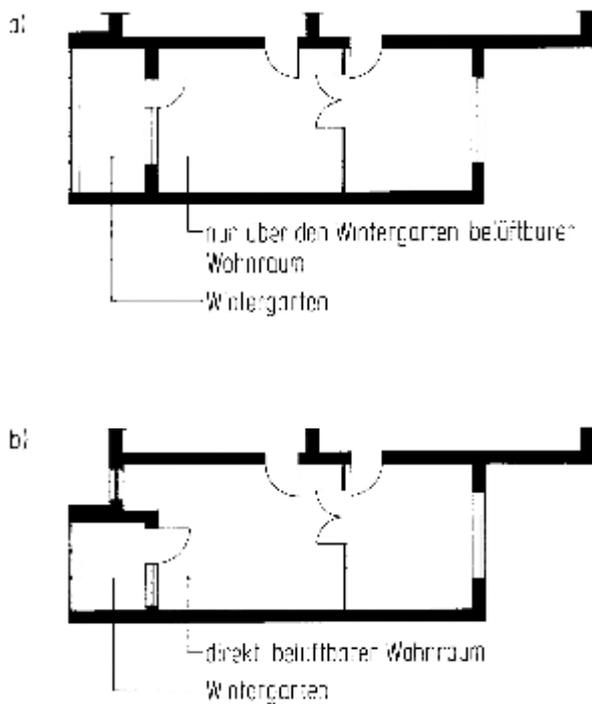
Eine verbesserte Grundrissgestaltung ermöglicht eine vom unbeheizten Glasvorbau (hier „Wintergarten“) unabhängige Belüftung des dahinter liegenden Wohnraums [2.1]
